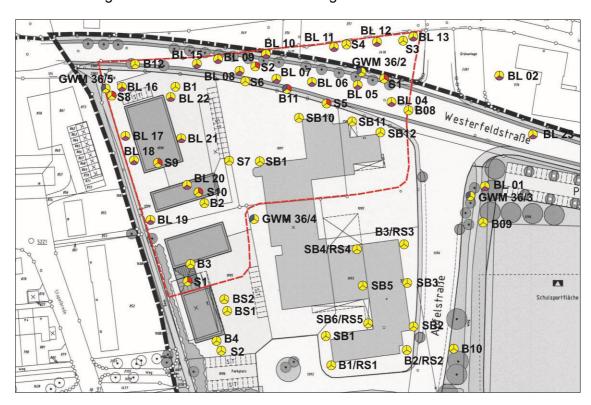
Auszug aus dem Lageplan zur Altlastenuntersuchung von 2005 mit Darstellung der Bohrungen/
